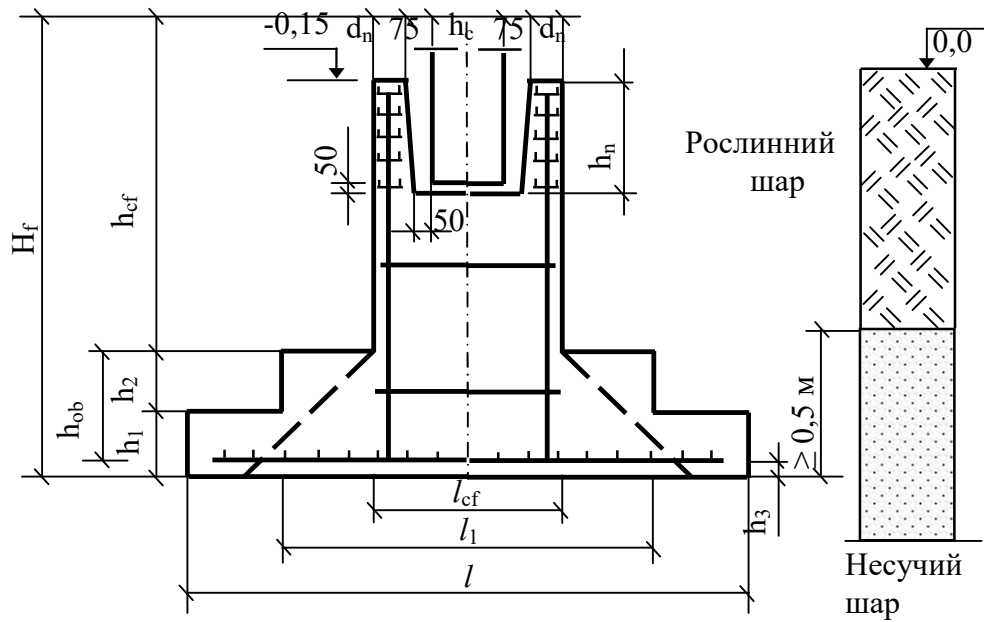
Конструкція фундаменту під збірну колону з підколонником
